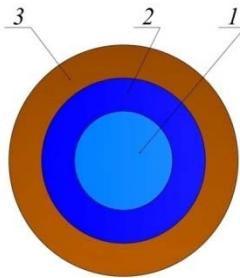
Поперечное сечение буроинъекционной сваи ЭРТ (РИТ, ФОРСТ, ЭРСТ): 1 – железобетонное сечение свай ЭРТ; 2 – зона цементации; 3 – зона уплотнения
